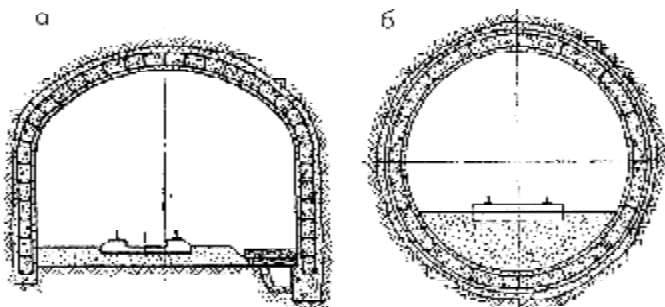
Залізобетонне кріплення з гнучкою арматурою:
